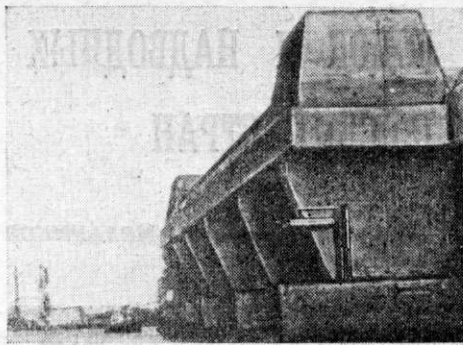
Железобетонное укрытие на французской ВМБ Лорьян
